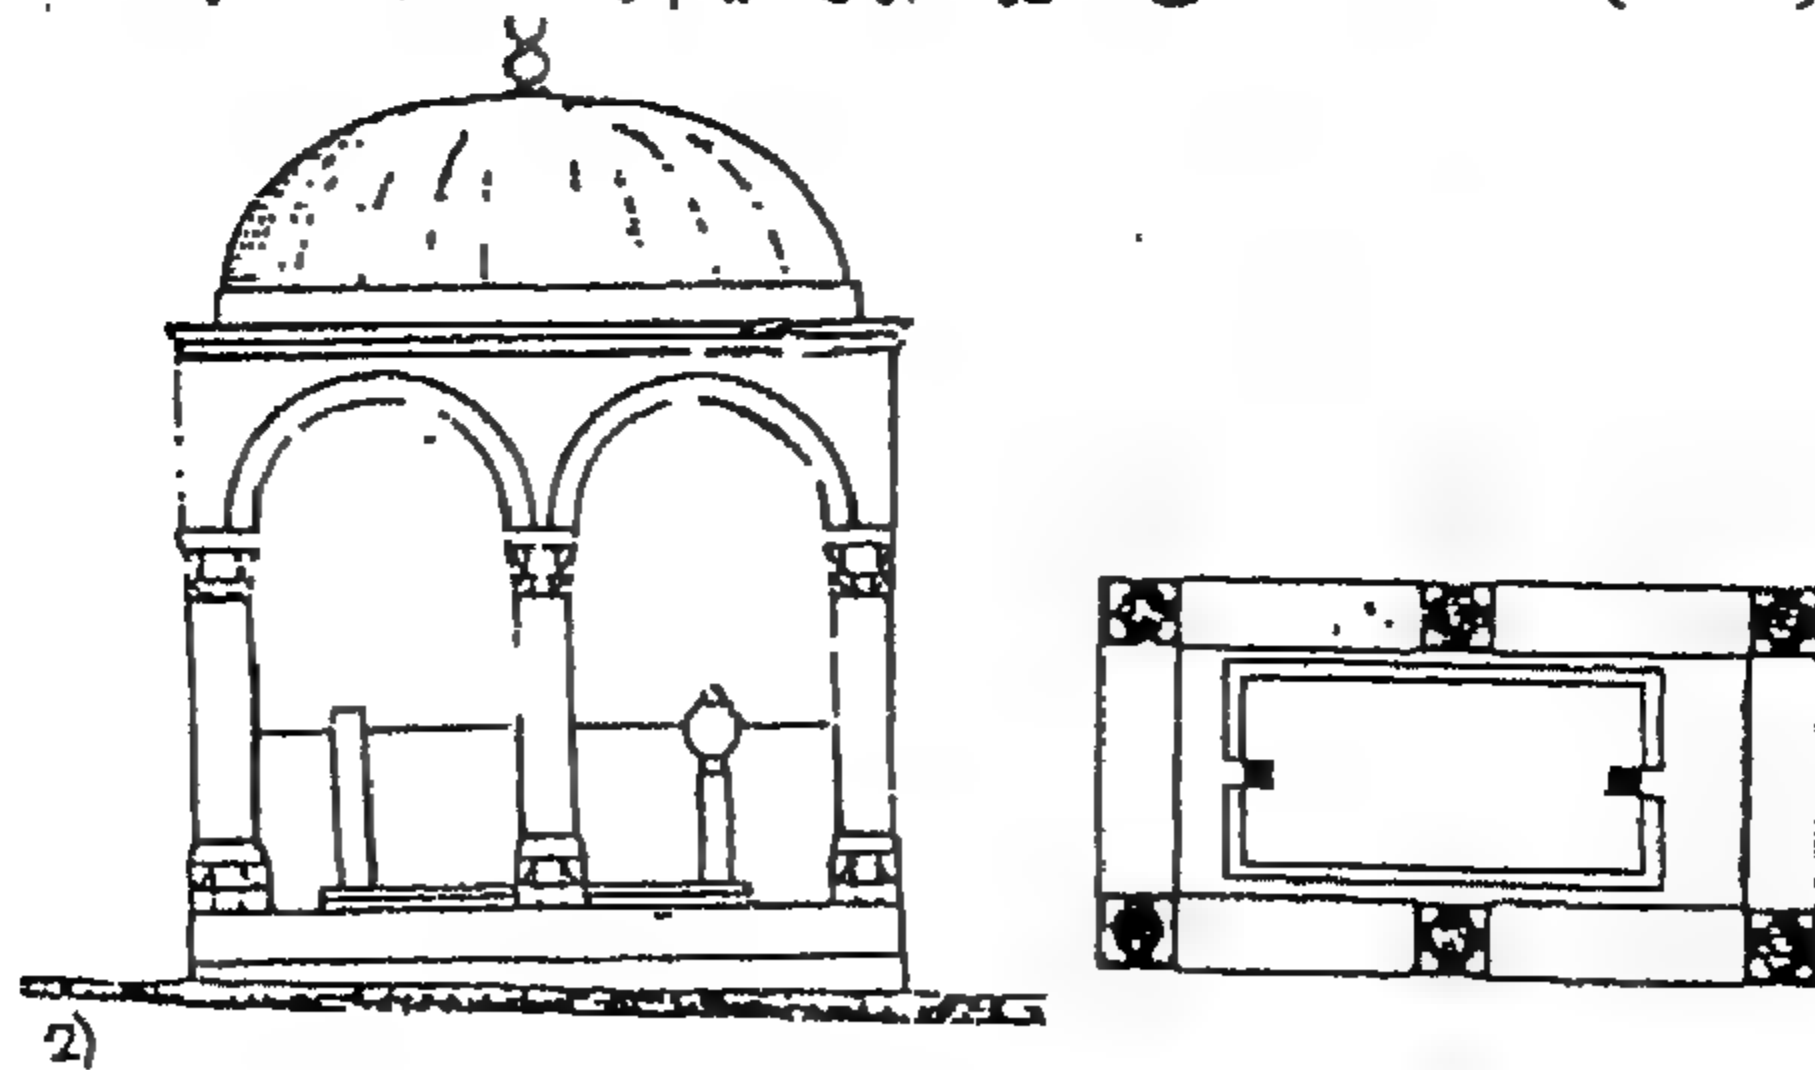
مسقط أفقي لتربة خاصكى حرم بمجمع السلیمانیة باستانبول
